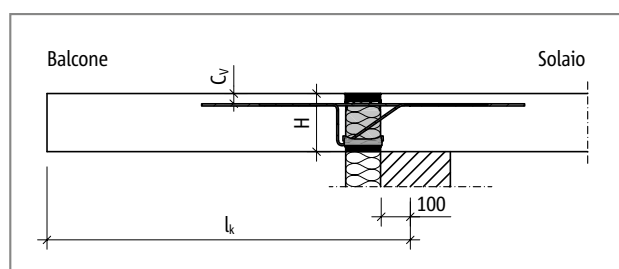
Schöck Isokorb® XT tipo KL: schema statico
